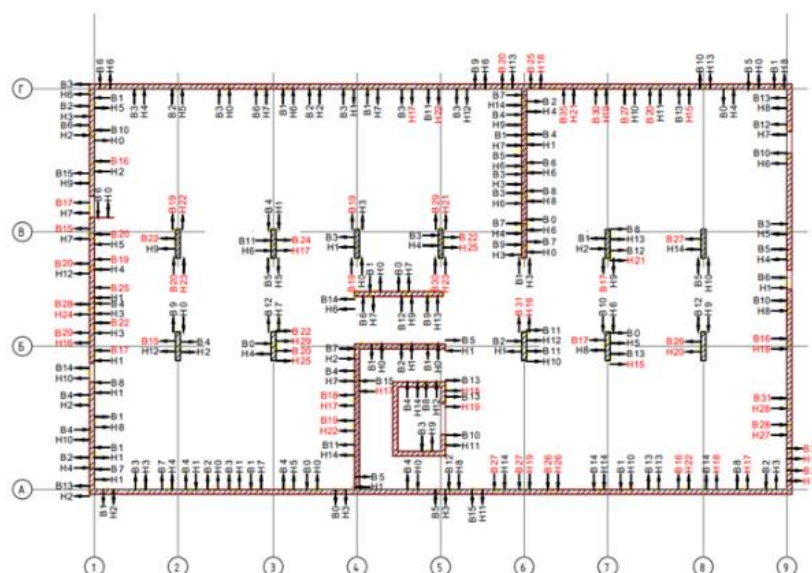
Схема исполнительной съемки смещения вертикальных конструкций монолитных плит по данным геодезических наблюдений
